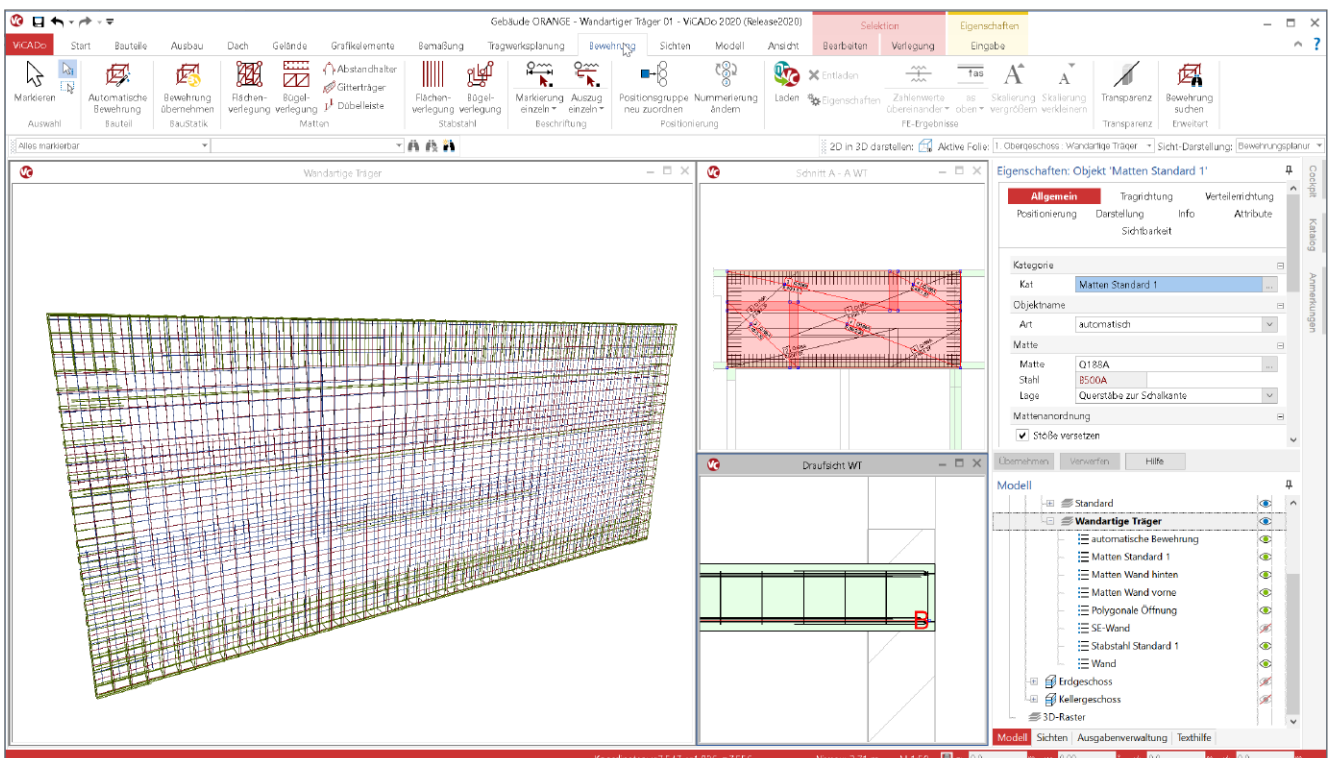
Bewehrung in ViCADO.ing, übernommen aus S360.de
